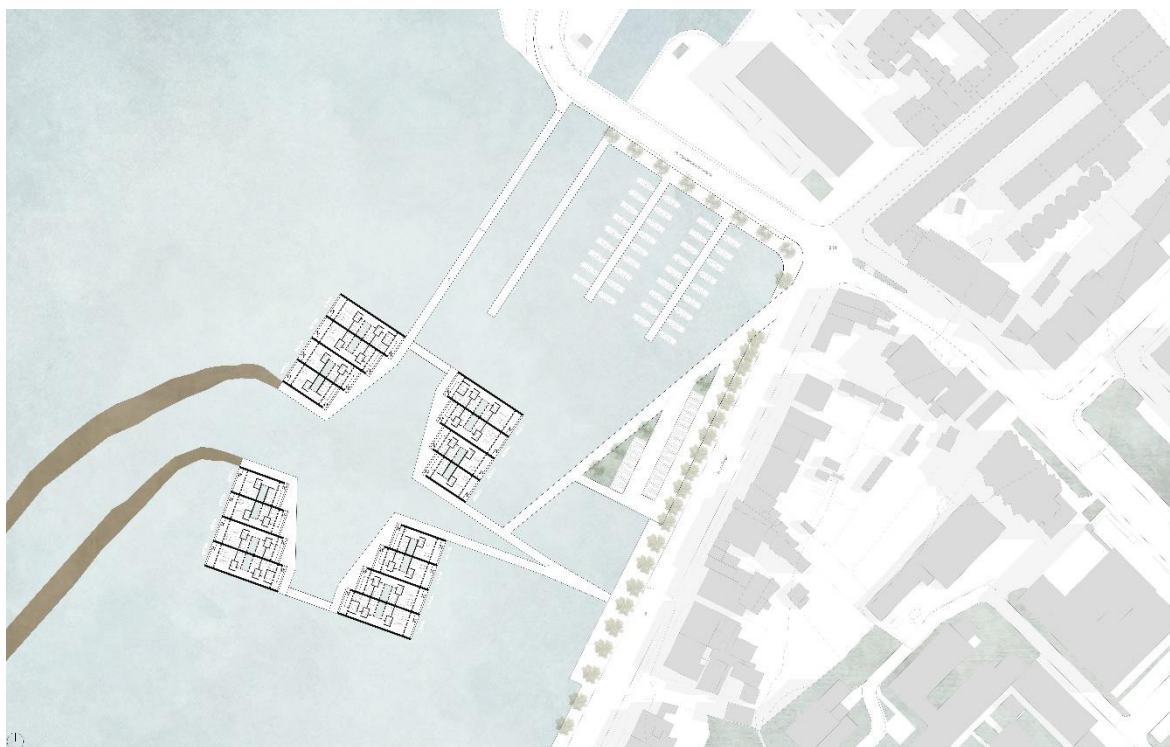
| Planta Terreno piso 1, Lago do Paraíso, Aveiro (Ilustração do autor, 2023)
